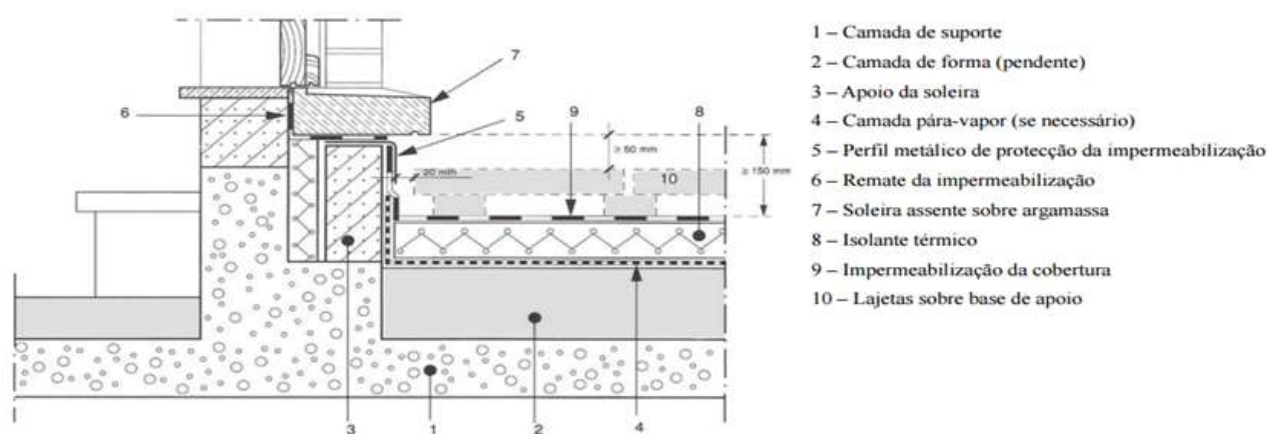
Pormenor construtivo face a uma soleira (CSTC, 1994)
